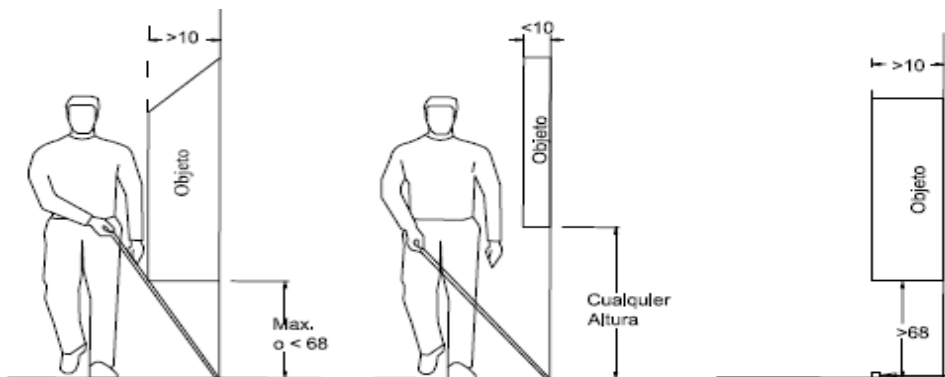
Dimensiones de objetos que sobresalen. Diseño accesible (MTA.SEDUVI)
